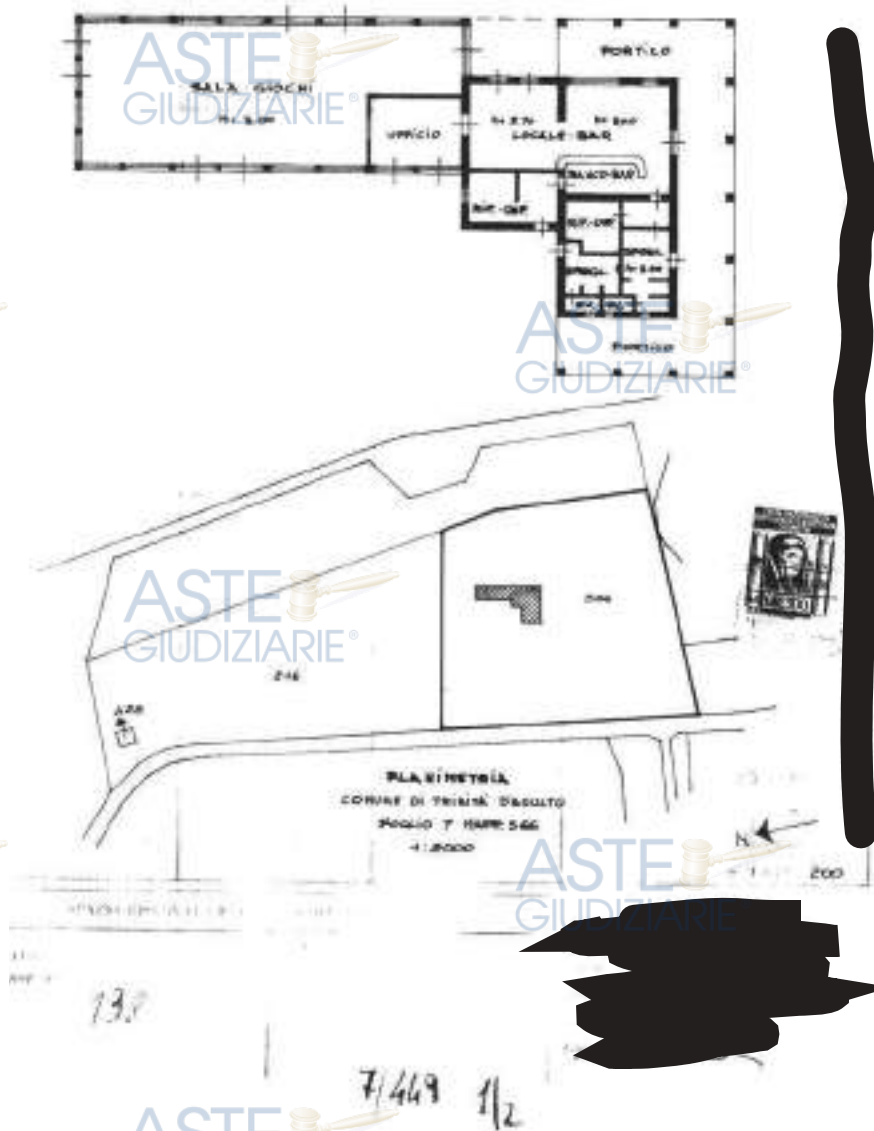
Ubicazione planimetrica dei beni immobili pignorati S2 Sporting Center
